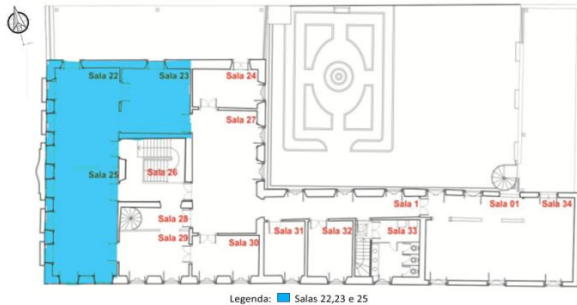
Planta baixa do segundo pavimento do Casarão 02.
